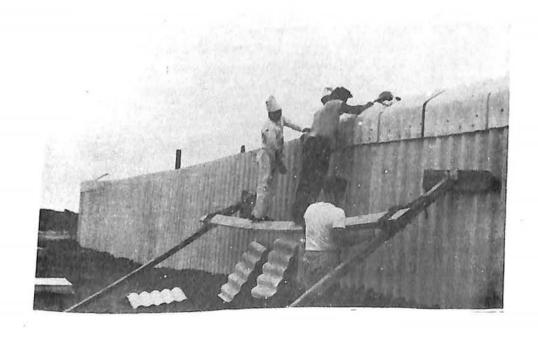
CASA DE INGENIEROS; VISTA DE LA CONSTRUCCIÓN.
